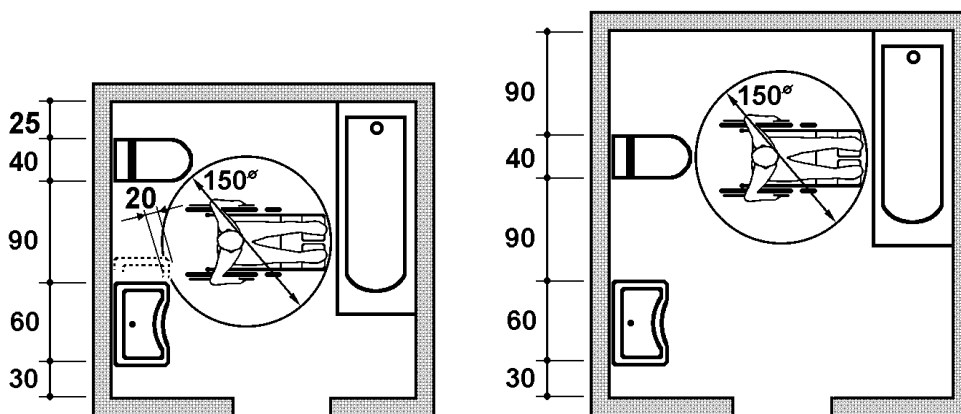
Günstige Maße für Badezimmer; nach [Öno 94, Hew 98a]
